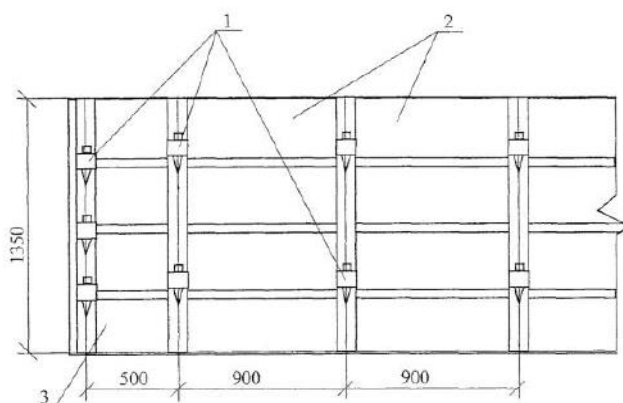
Схема соединения щитов опалубки: 1 - клиновые замки системы «Мева»; 2 - опалубочные щиты; 3 - доборный элемент
